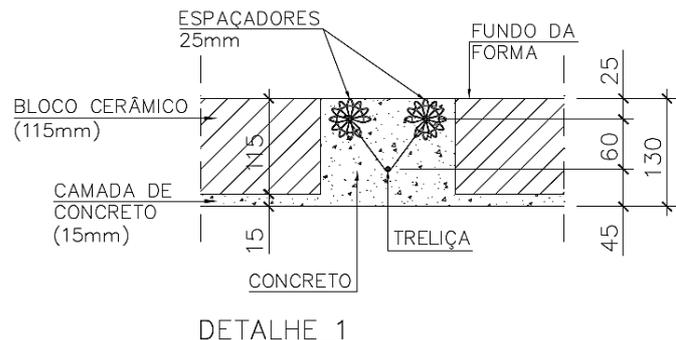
Detalhe esquemático do posicionamento das armaduras nas nervuras
